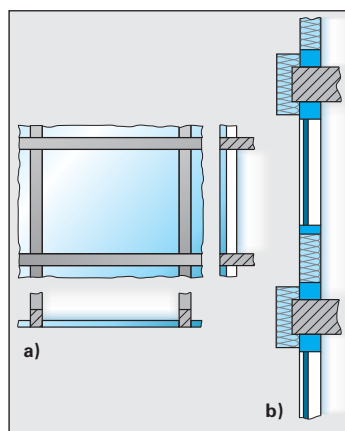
a) Fasadelement mellan bjälklagsplattorna och pelarna, b) Våningshög utfackningsvägg som varmfasad ("indragen" fasad).
